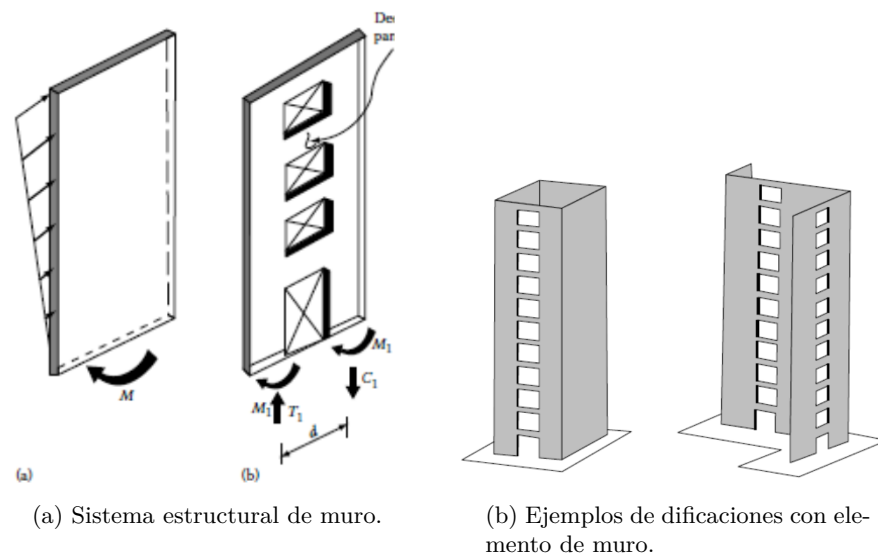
Ilustraciones sistema de muros, Ref.: Reinforced Concrete Design of Tall Buildings, Taranath, B. S., CRC Press, 2010.
